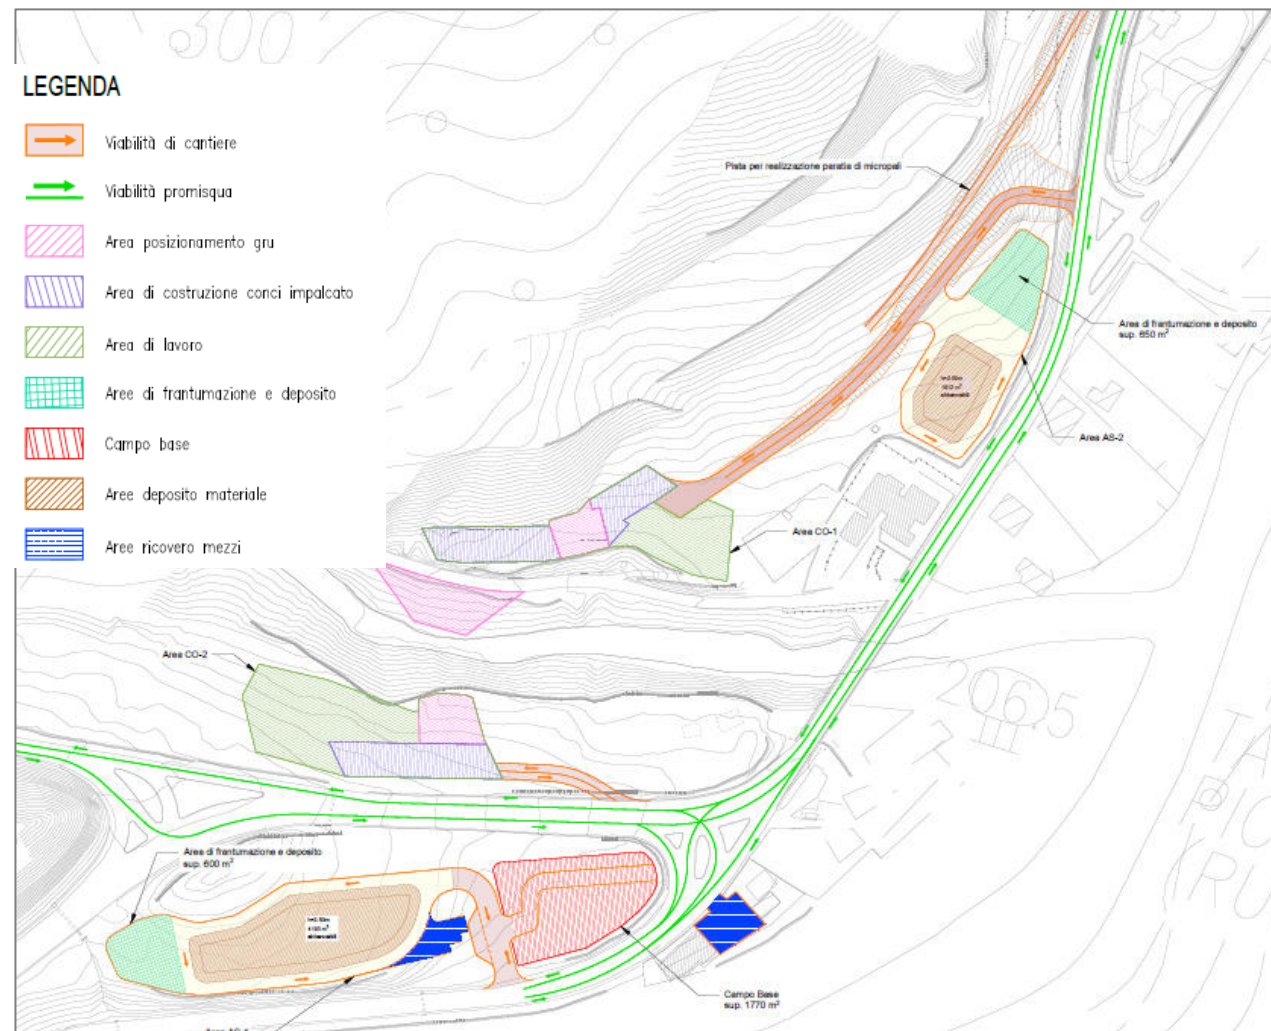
Localizzazione cantieri e viabilità di servizio
